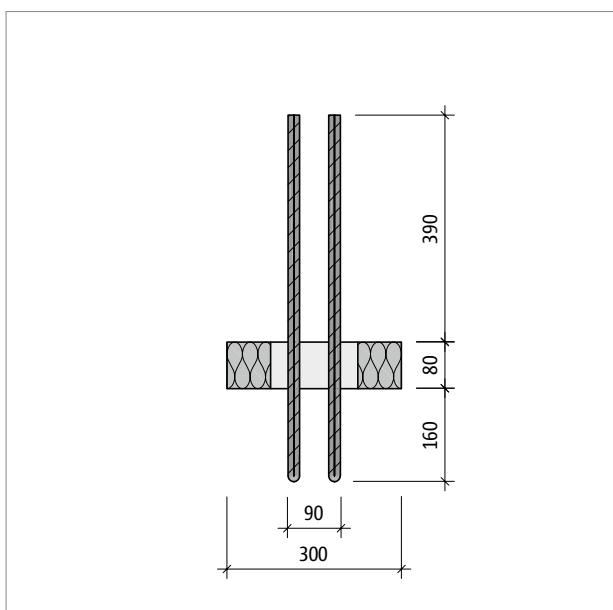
Schöck Sconnex® type W-N-VH : coupe B-B du produit
